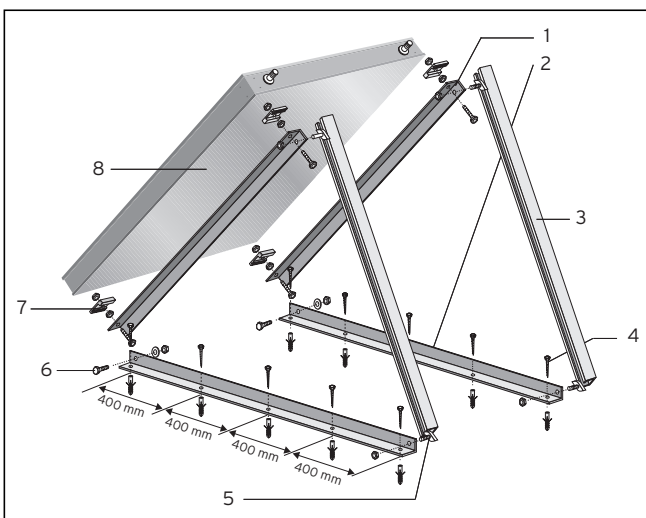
Module de base pour montage sur toit plat et pour montage vertical des capteurs
